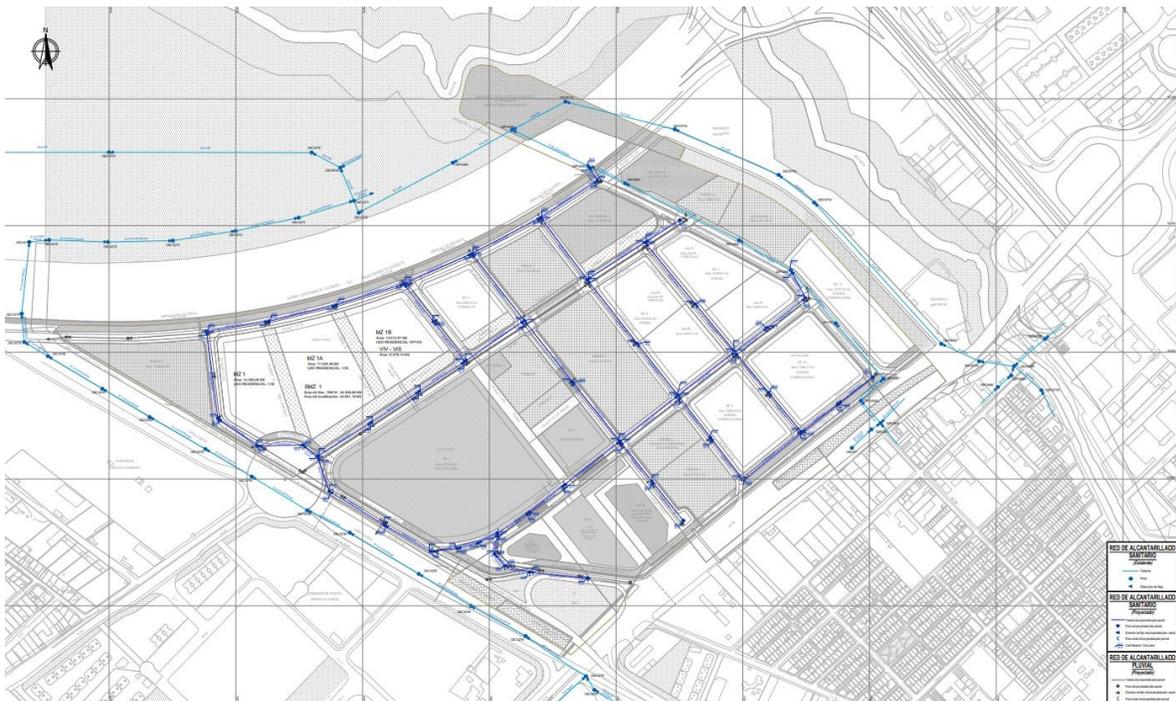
Plano de la red proyectada de alcantarillado sanitario PPD – Tramos, pozos, cotas
